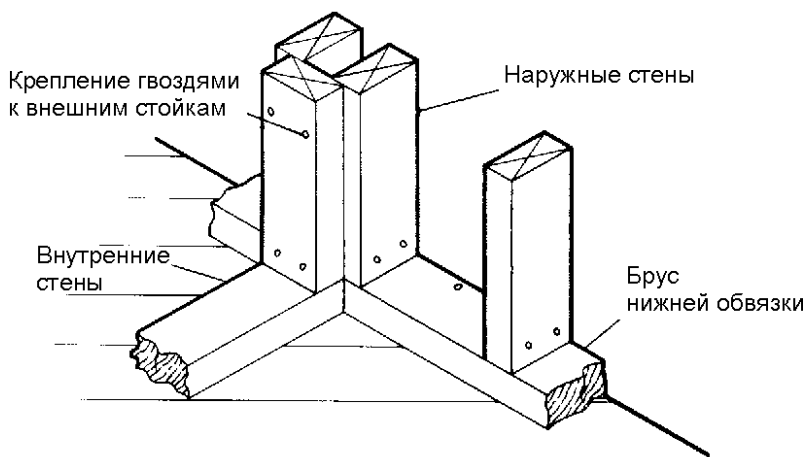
Стены перегородок крепятся гвоздями к специальным сдвоенным стойкам в наружных стенах (Forest Products Laboratory)
